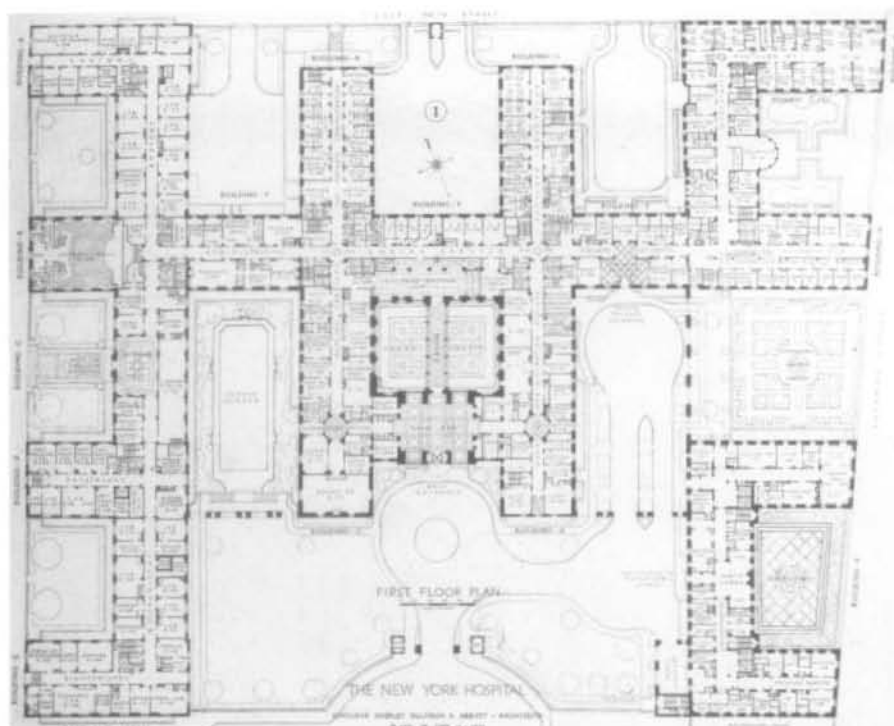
Cornell Medical Center, plan du rez-de-chaussée. (Photo : tirée de *Hospital Planning*, Charles Butler et Addison Erdman, F.W. Dodge Corporation, 1946)
